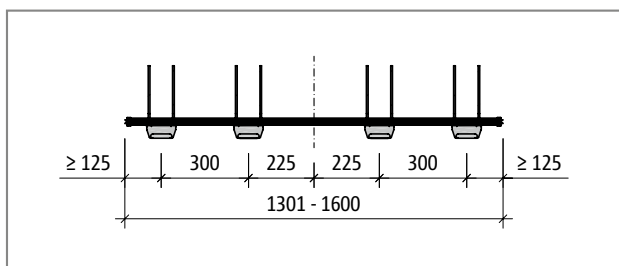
Schöck Tronsole® type T-V4-H...-L1301 to L1600: Product layout
